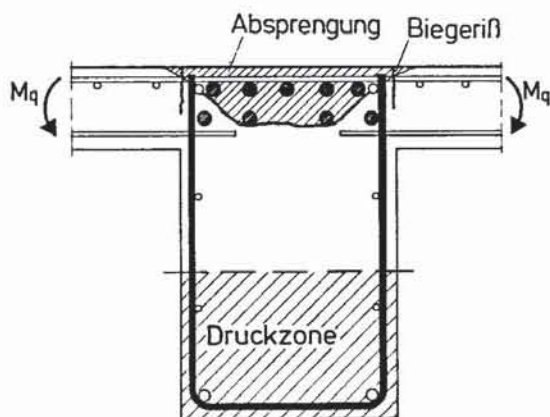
Absprengen der Betonschale im Stegbereich eines Plattenbalkens mit offenen Bügeln (nach [46])
